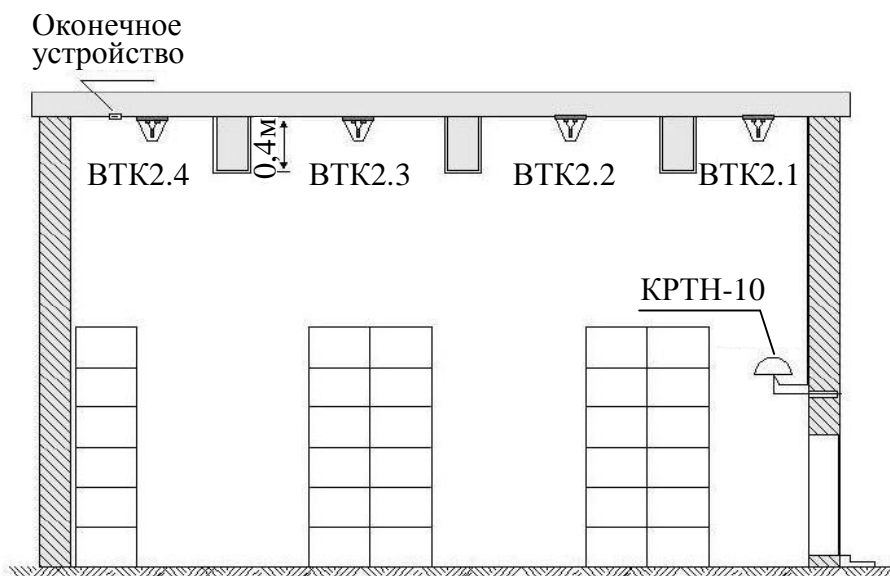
Размещение АПИ на потолке помещения с выступающими ребрами перекрытия
